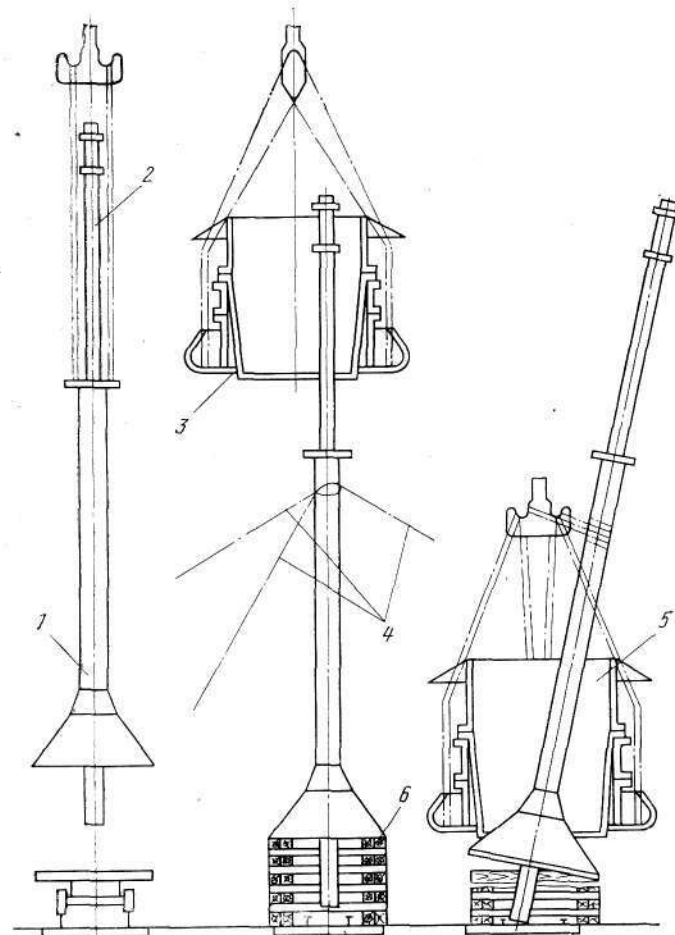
Схема укрупнительной сборки штанг конусов с распределителем шихты в монтажный блок
